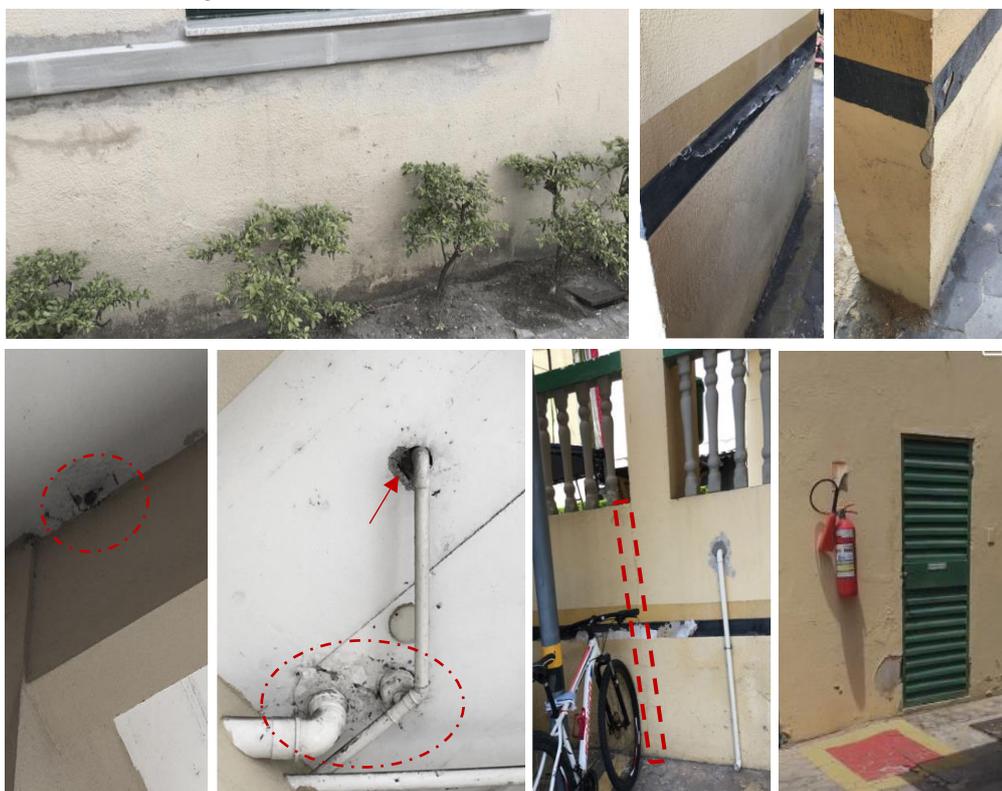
Fissuras e pintura avariada Ed. B
